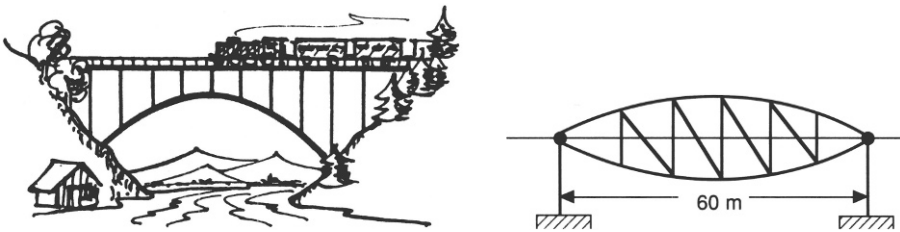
Brücke mit (a) einem, (b) zwei Parabelbögen
